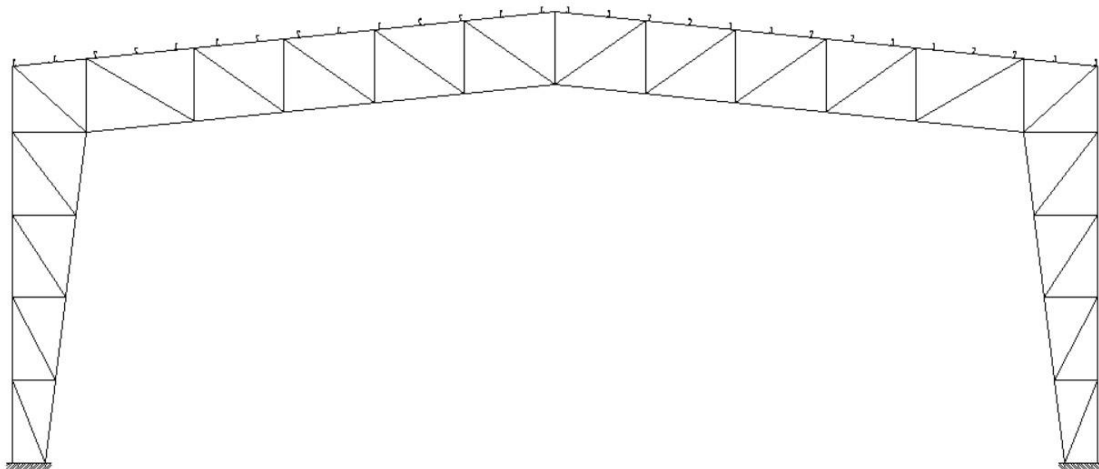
Correas de cubierta sobre el pórtico interior de la estructura
